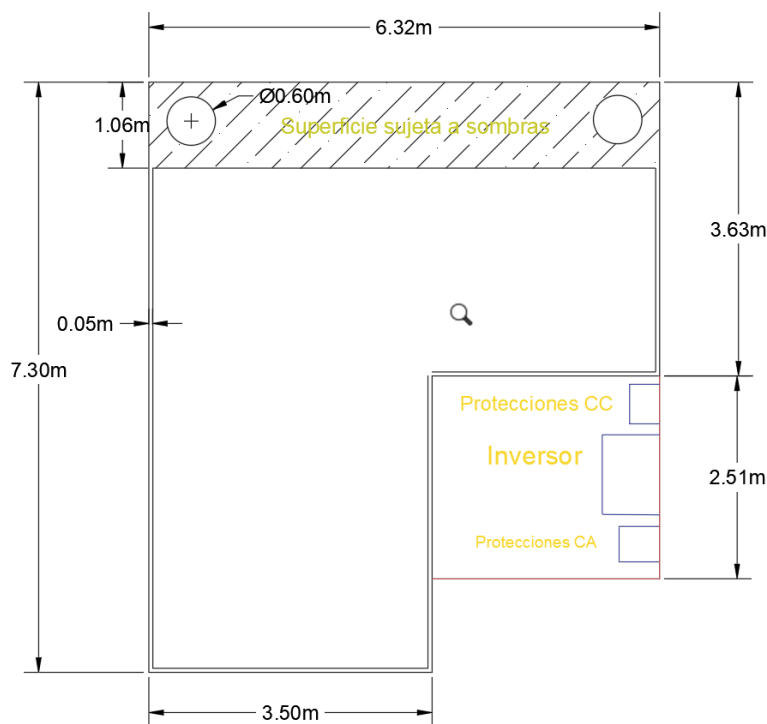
Boceto de la planta del tejado sur de la vivienda unifamiliar. Placas de dimensiones 2x1m
